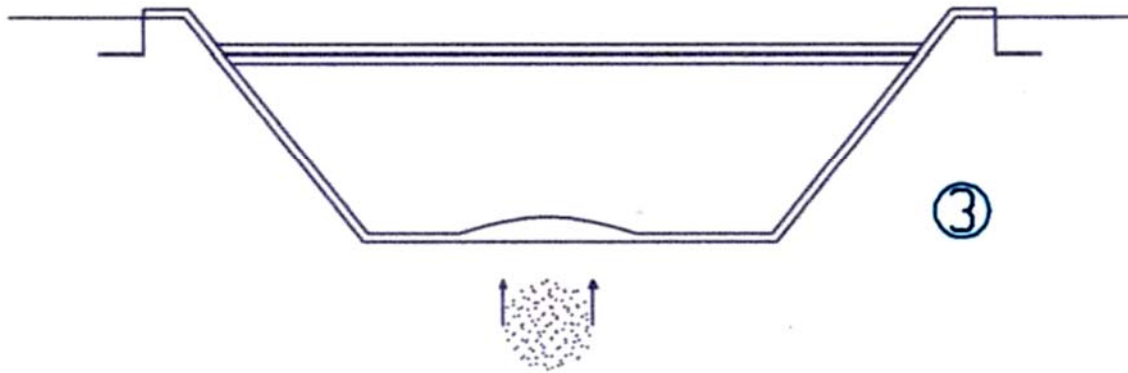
La disolución del material orgánico debajo del sistema de impermeabilización puede llevar a la sub-presión por debajo del sistema de impermeabilización.
